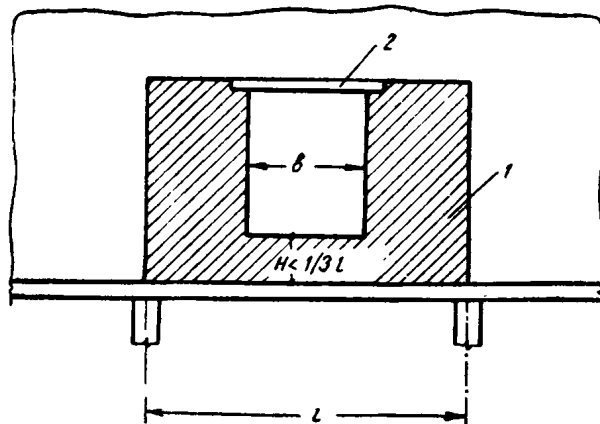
Схема нагрузки на рандбалку при наличии проема в стене
